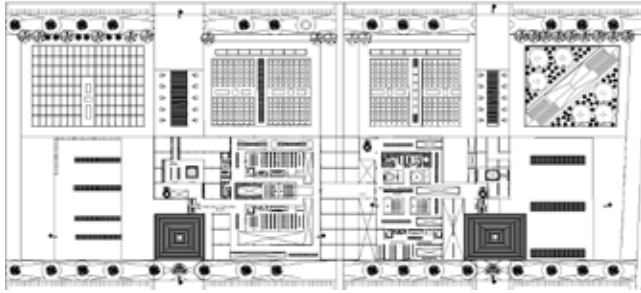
Planta Nivel 2. Fuente: Schaverin (2021)
